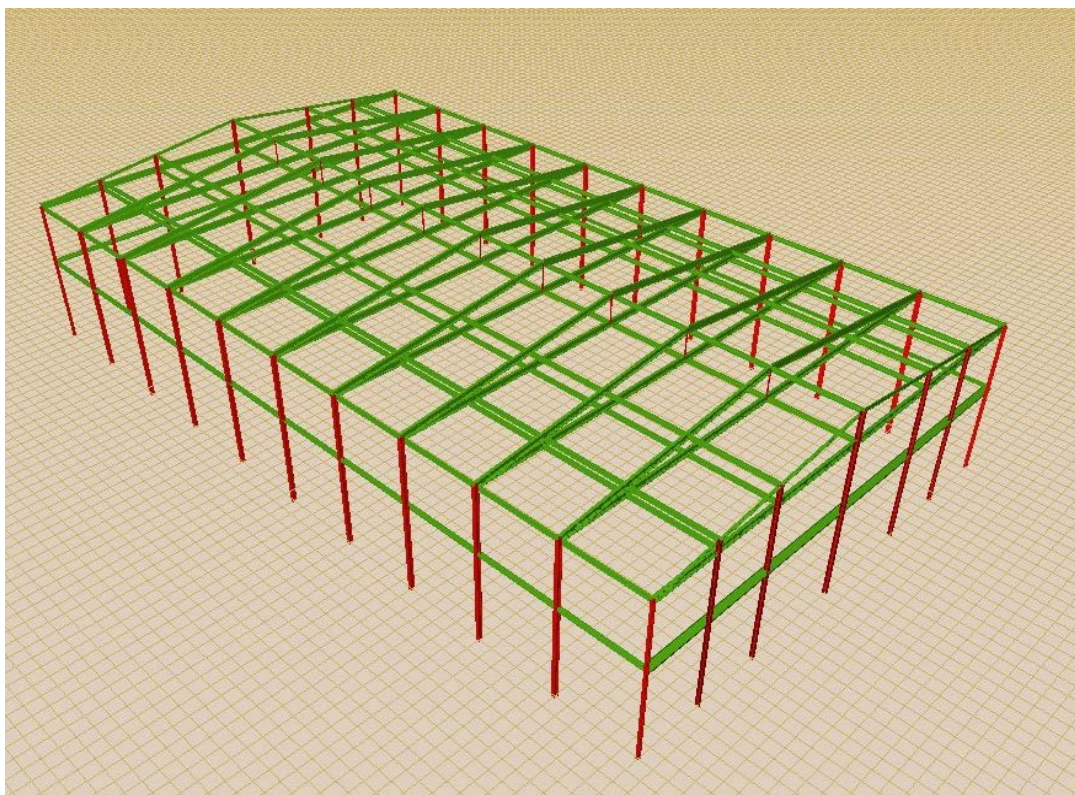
Imagen 3D Pórtico rígido perfiles laminados
